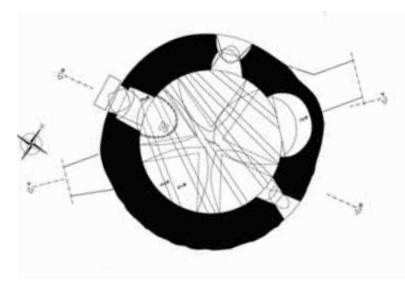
Grundriss Stein, M 1:200. Bauaufnahme der TU Wien 2002, Planarchiv BDA Wien.
